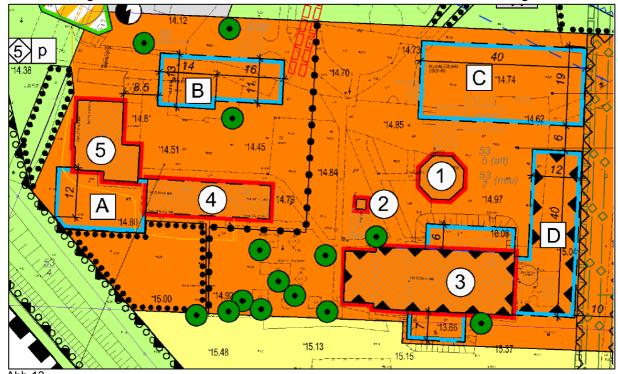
Übersicht zur Höhe der Baukörper in den Sondergebieten (Quelle: Entwurf zum B-Plan)
